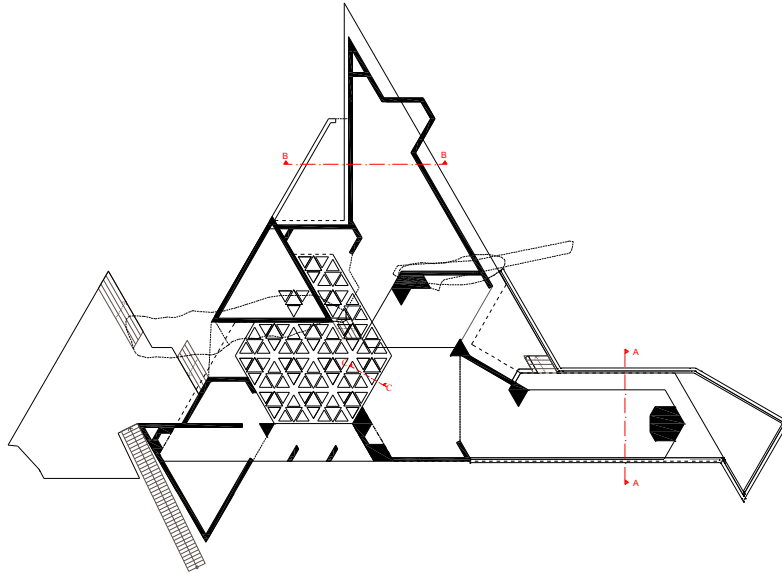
Pianta della Casa Massaro con indicate le due sezioni in esame
